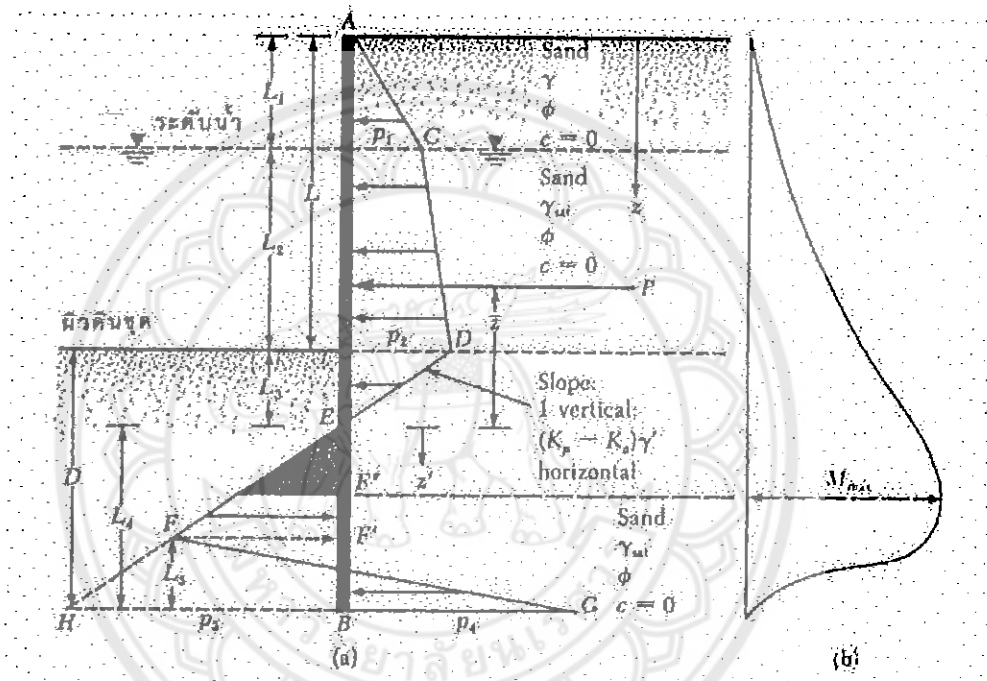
แสดงลักษณะของ Net Lateral Pressure หรือแรงดันด้านข้างสุทธิของดินบน Cantilever Sheet Pile Walls ฝังใน Sandy Soil โดยมีรายละเอียดดังนี้
